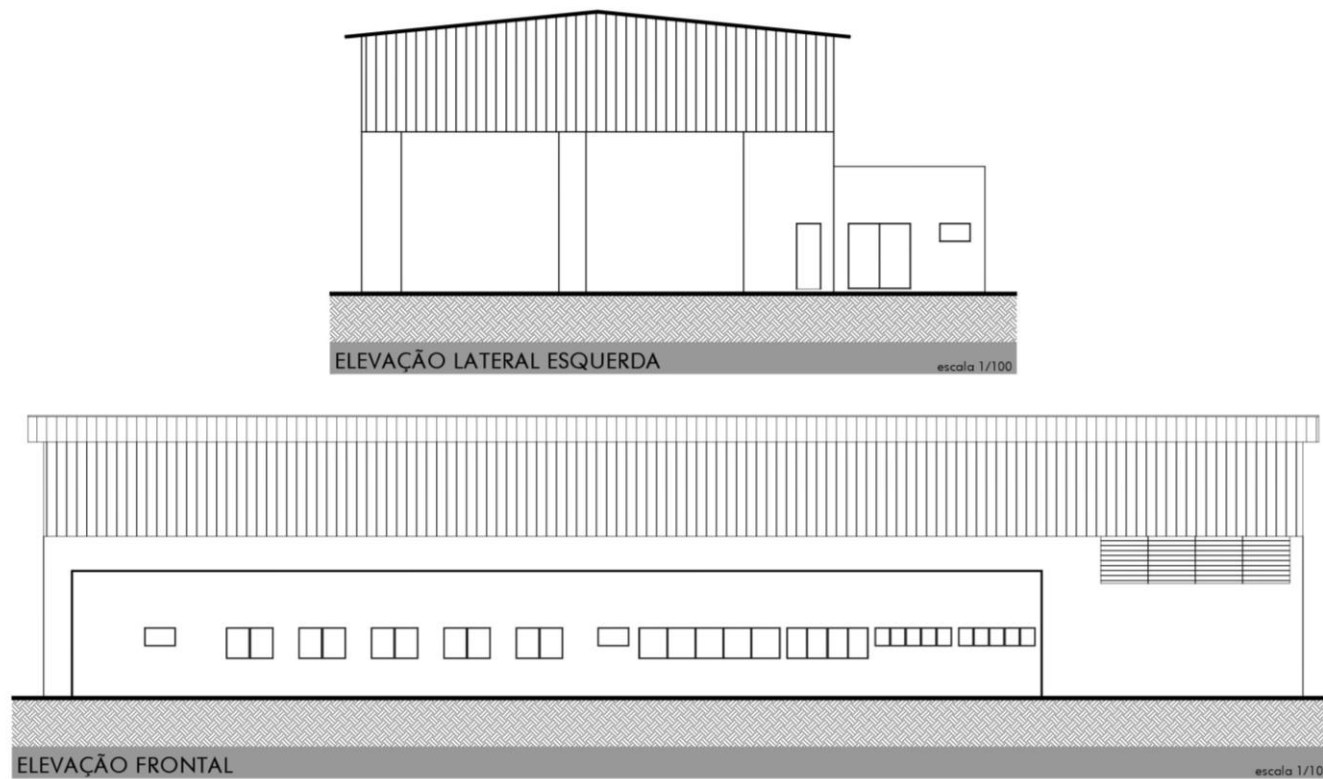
Rercorte (Folha 4/5) do Projeto Arquitetônico: Elevações
